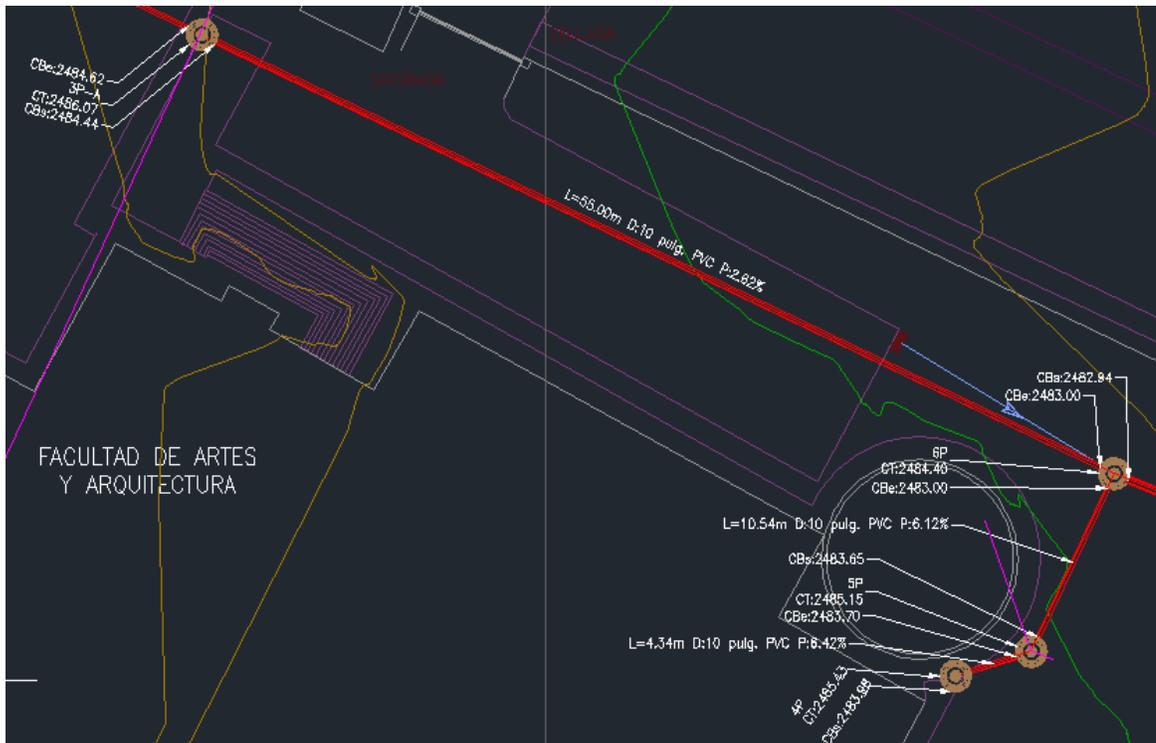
Diseño alcantarillado pluvial tramo 3PA a 6P; 4P a 5P; 5P a 6P
